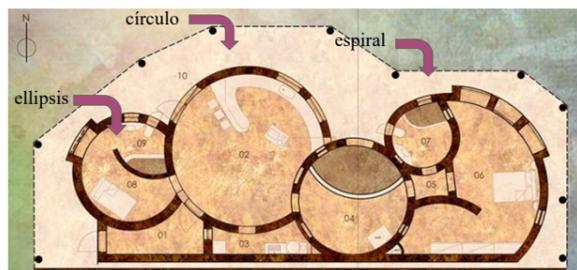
Planta del proyecto arquitectónico de la vivienda "Susurros del viento" | Fuente: "Debarro Arquitectura"
